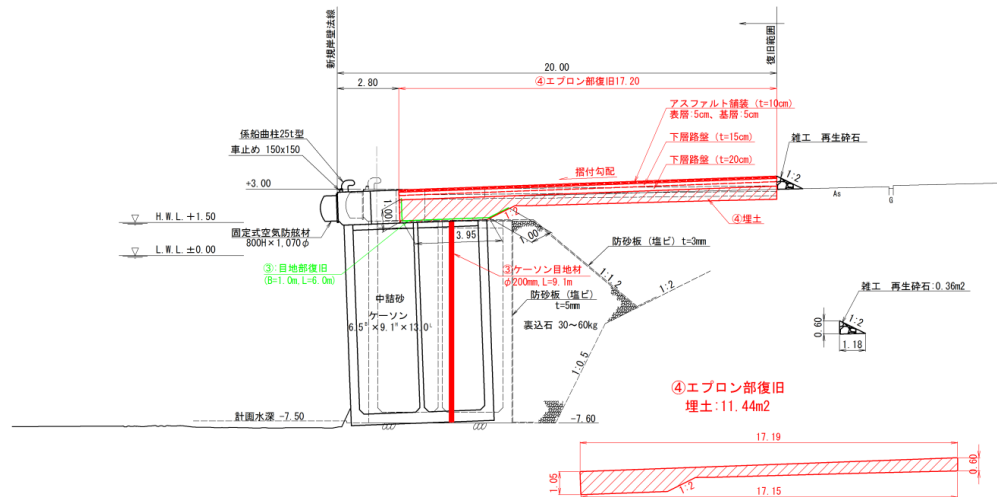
168 No.7 日立港区\_第2ふ頭地区 2-D岸壁 (-7.5m) の断面図 No.3 (復旧後)
